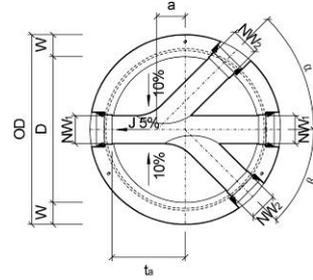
Grundriss CRENO Normschachtboden Typ 2
